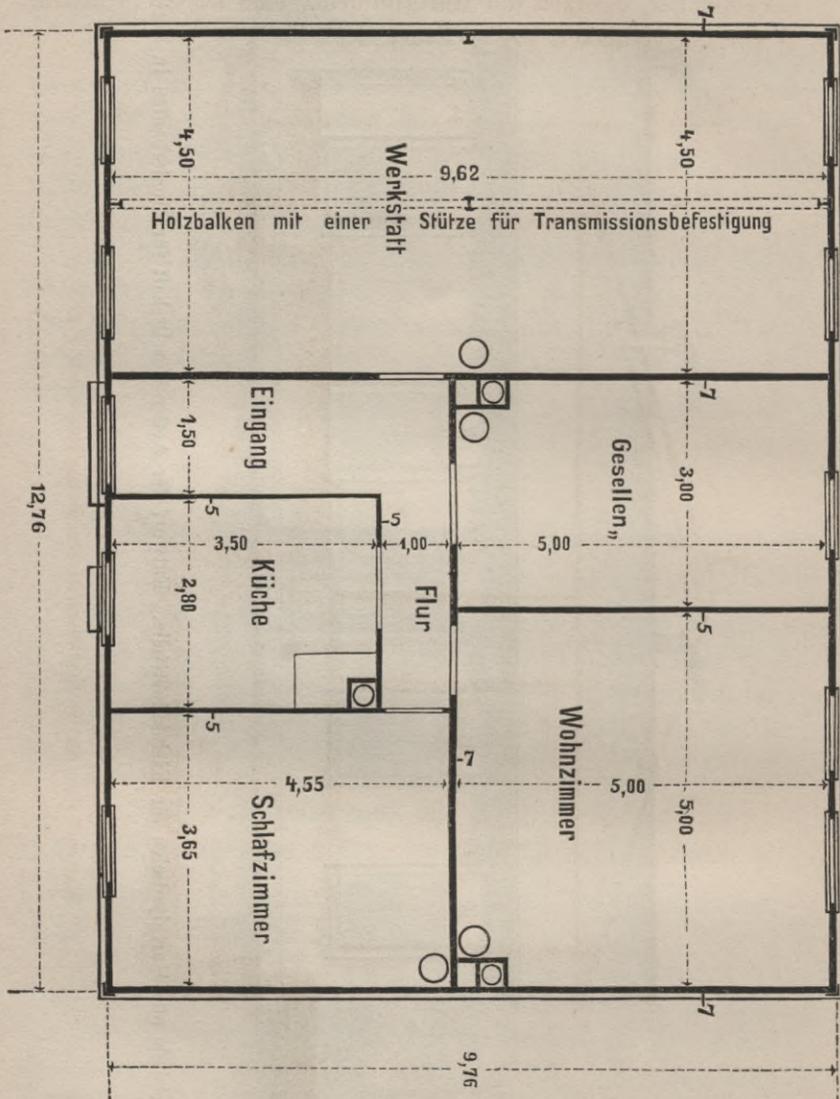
Grundriss des Gebäudes aus Hartgipsdielen für Kleinindustrielle.
